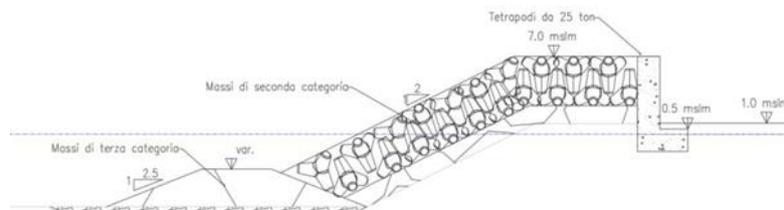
Sezione tipologica dell'area del faro (Sez.K)
